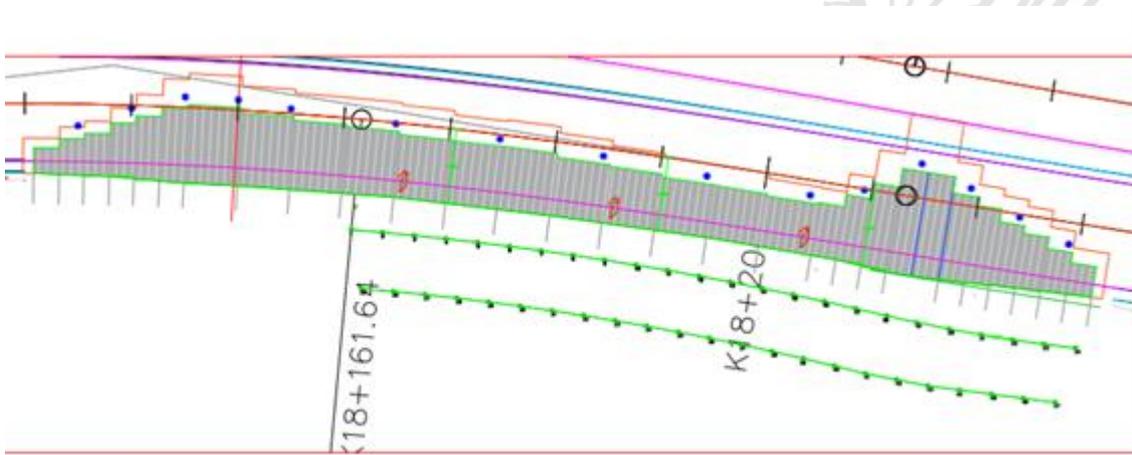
Vista en planta de Sitios críticos #3 correspondiente a proyecto VINUS (Suministrado por SP)
